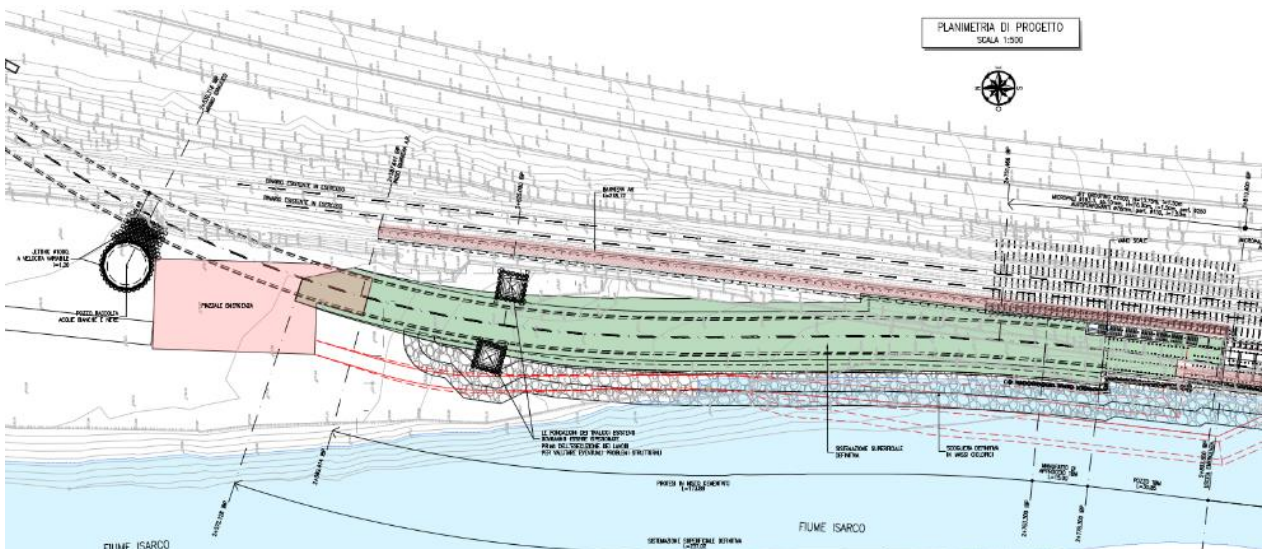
Progetto Esecutivo - Planimetria dell'imbocco (Parte 2/2)
